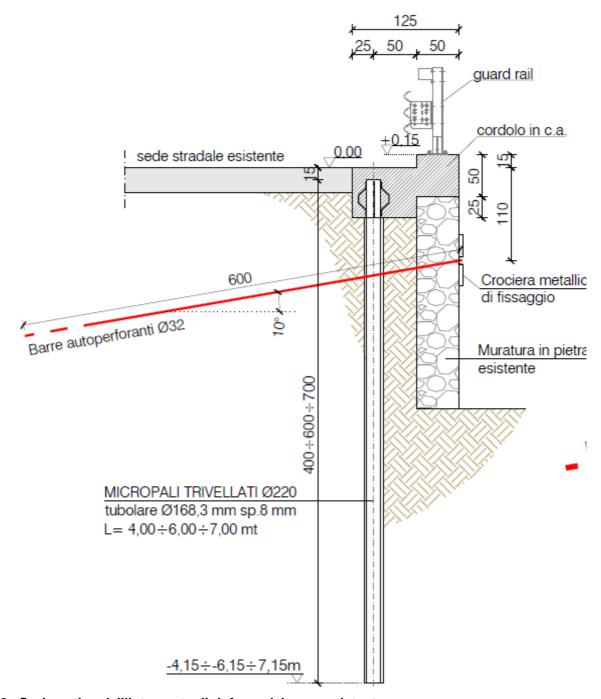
Sezione tipo dell'intervento di rinforzo del muro esistente.
